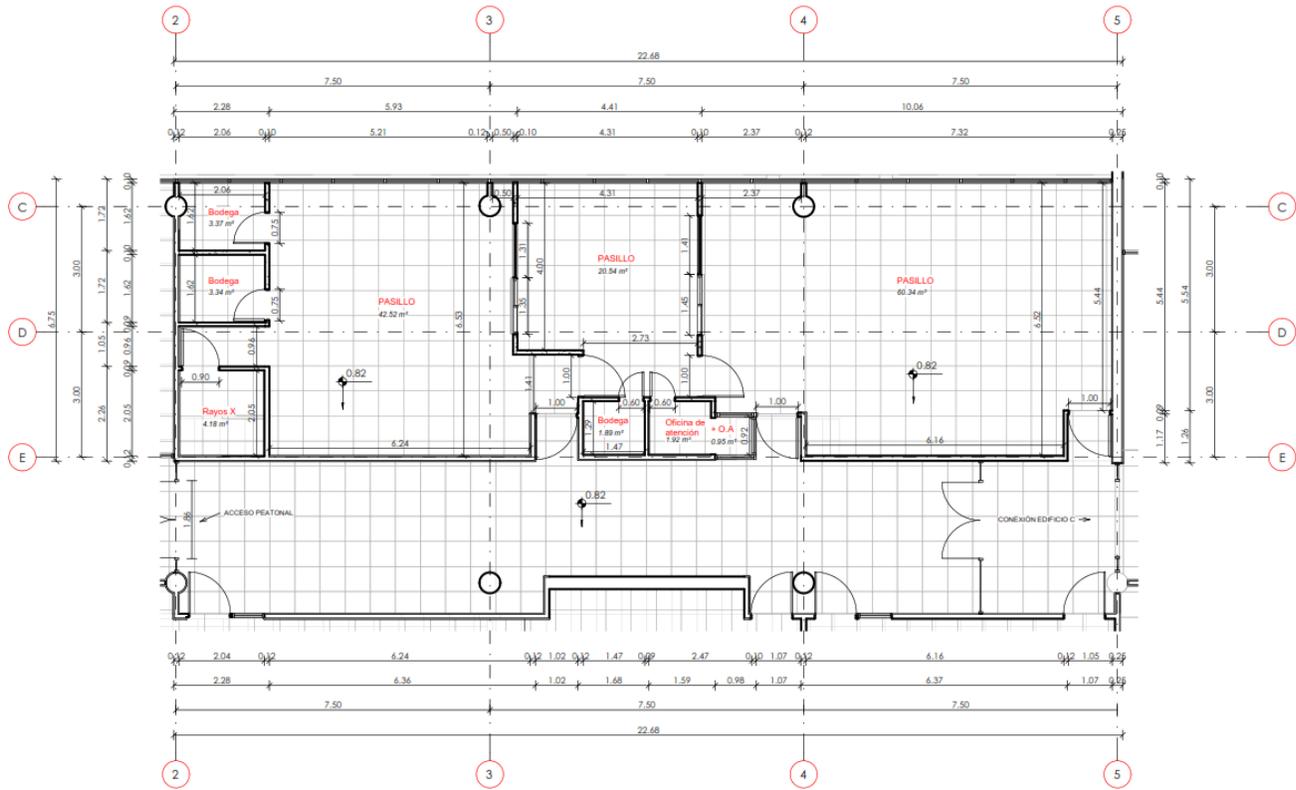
Plano arquitectónico del laboratorio preclínico.
